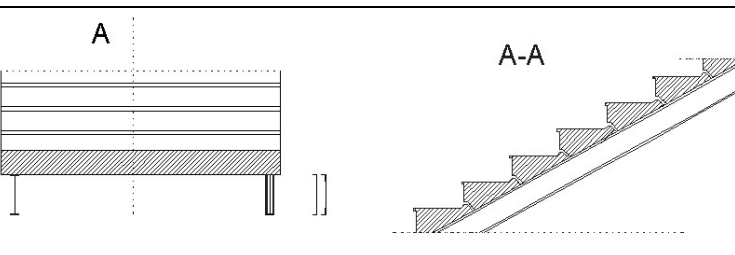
Scari cu structura mixta – detalii constructive
